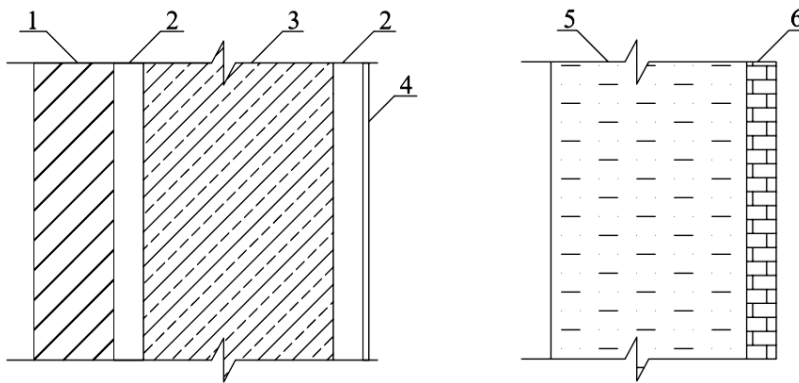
Схема четырехслойной пассивной солнечной панели (слева) и двухслойной утепленной наружной стены (справа): 1 – минеральная вата; 2 – воздушная прослойка; 3 – железобетон; 4 – стекло; 5 – пеноблок; 6 – облицовочный кирпич
